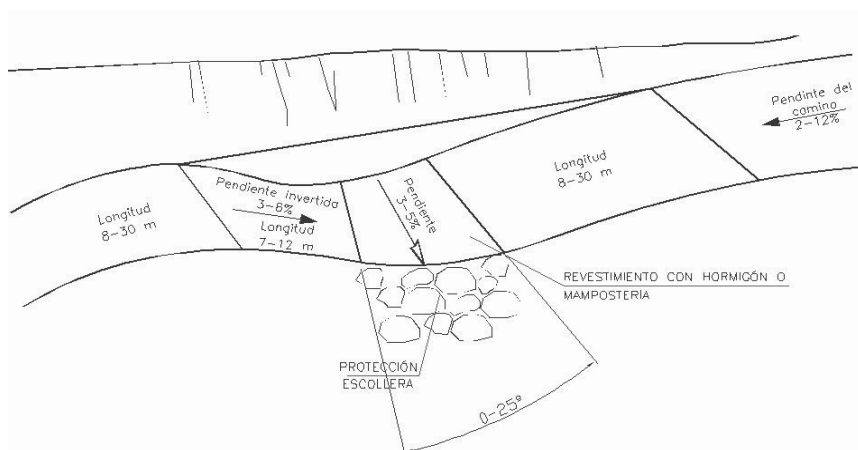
Croquis de vado ondulado sin cuneta longitudinal. Fuente: Elaboración propia.
